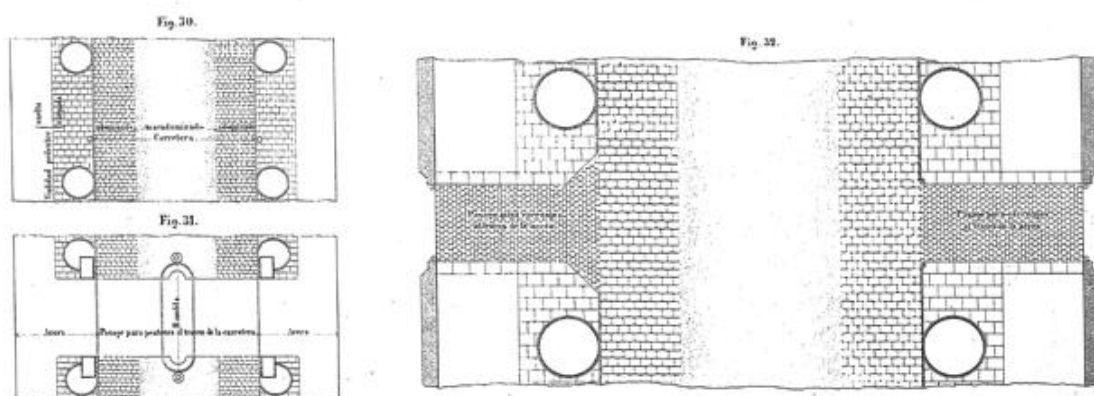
> Plantas donde se puede apreciar los cambios introducidos por Cerdà en la pavimentación de las aceras respecto el proyecto de 1859 (Cerdà ROP 1863, nº13, lámina 21.)
